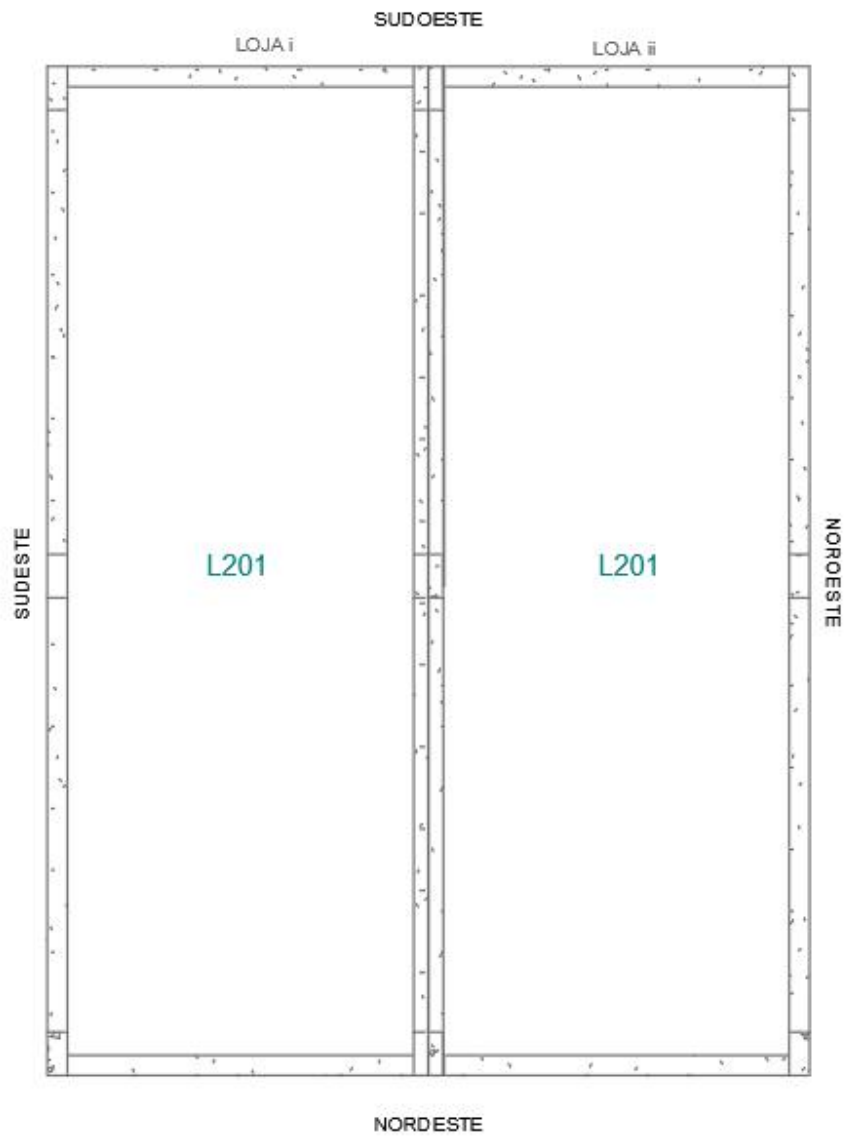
Levantamento fotográfico Lajes - CLS 105.
